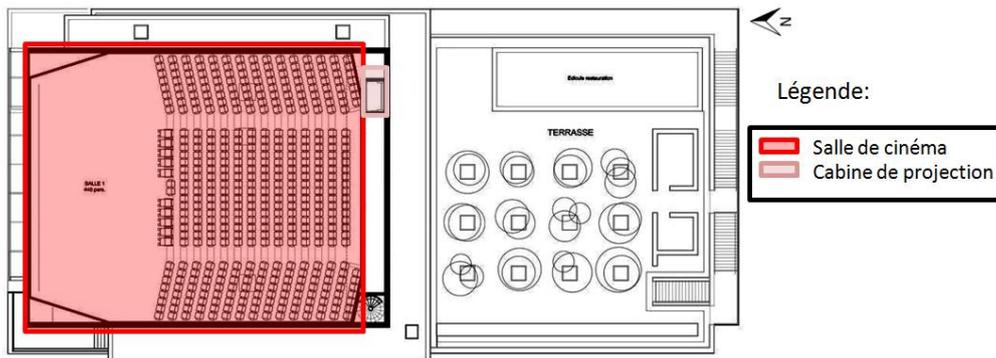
plan de niveau de salle 1 ; de 3eme étage. Source : source : www.archdaily.com traitée par auteurs.
